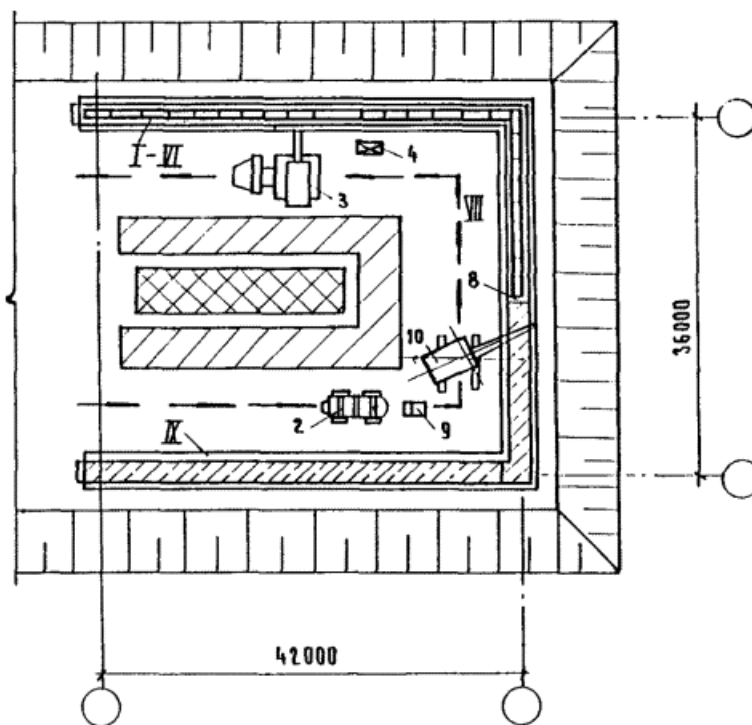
Схемы возведения монолитной железобетонной стены при укладке бетонной смеси с помощью стрелового крана
